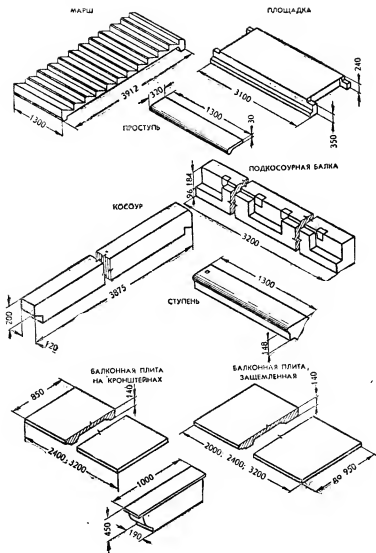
Сборные железобетонные элементы лестниц и балконов.
